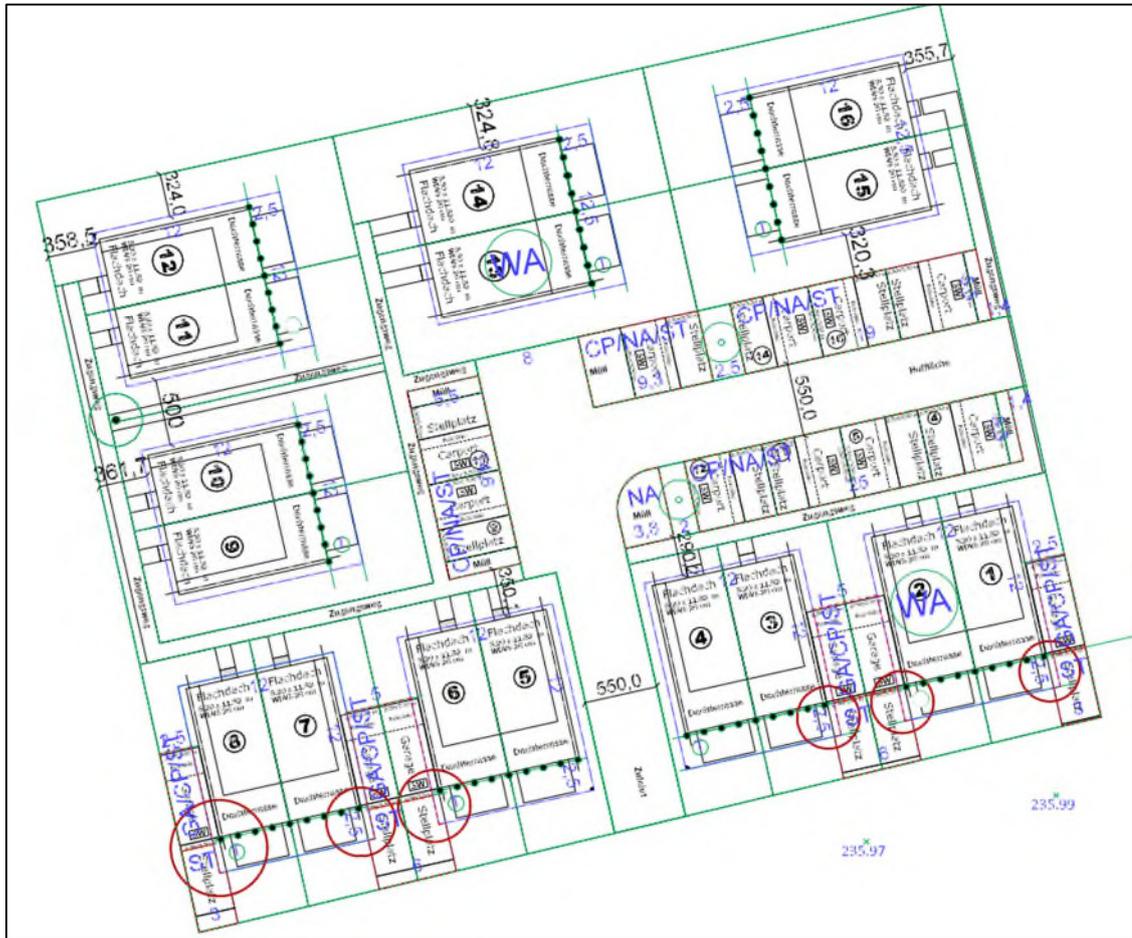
Übersichtsplan zur geplanten Bebauung innerhalb des Plangebiets
